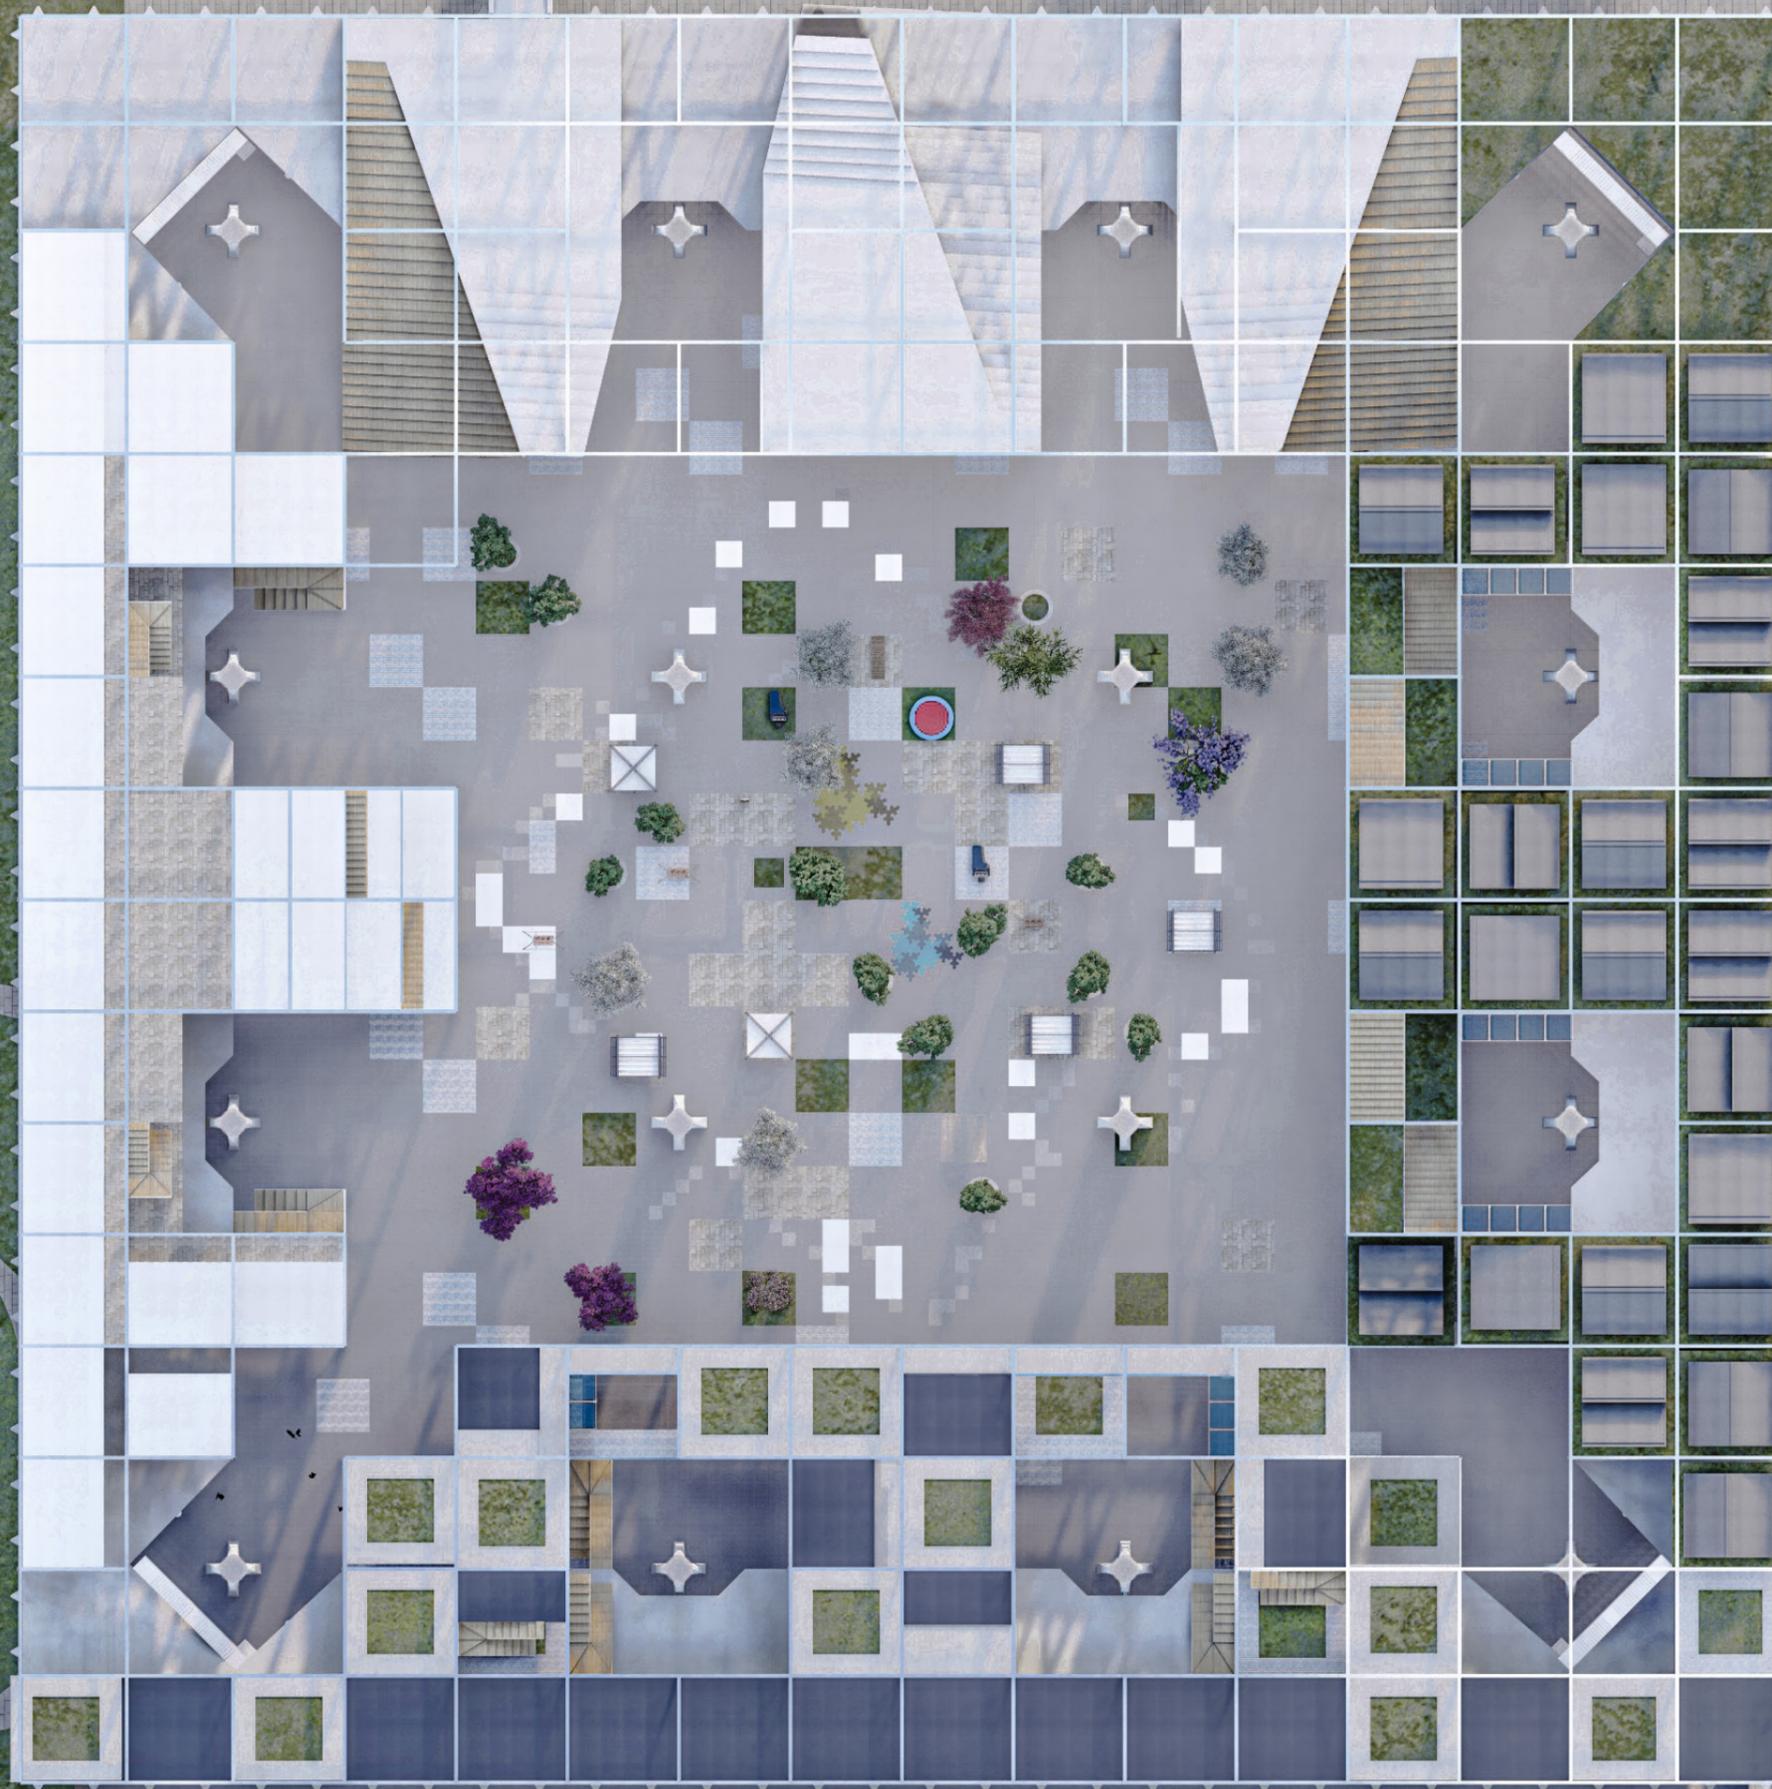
Pianta piano secondo dell'intervento Regole e Città nel Palazzo. Elaborato degli autori. Scala 1: 1000.
